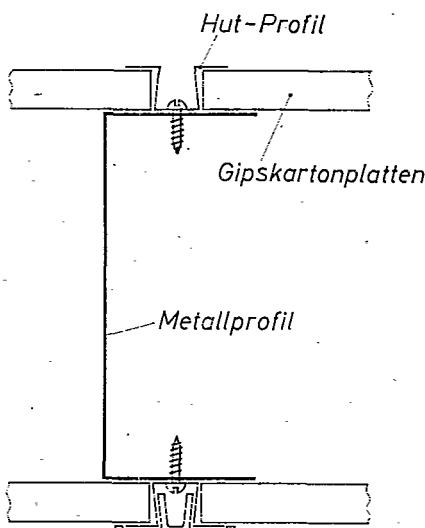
Beispiel für ein Metallprofil mit Klemmbefestigung (oben ohne, unten mit PVC-Deckprofil)
